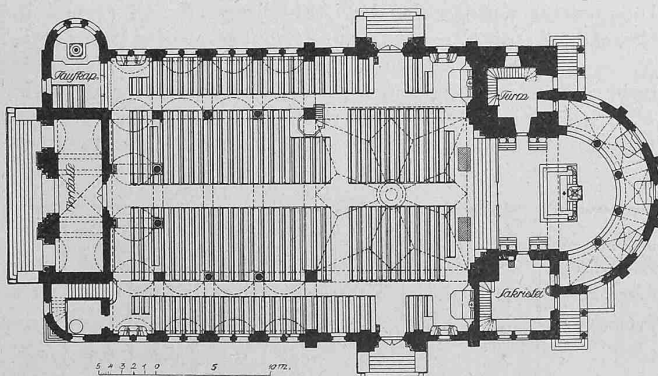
Grundriss der kath. Kirche Romanshorn. — 1:600.
